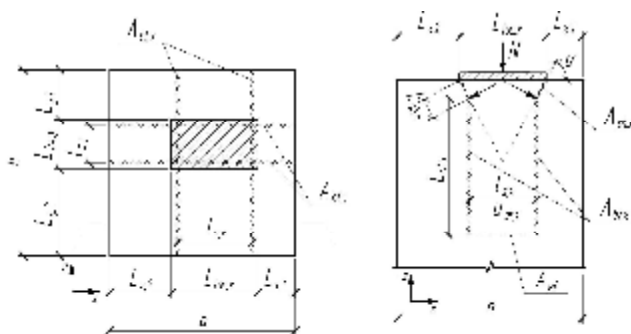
Расчетная схема оголовка железобетонной колонны при местном сжатии грузовой площадкой
